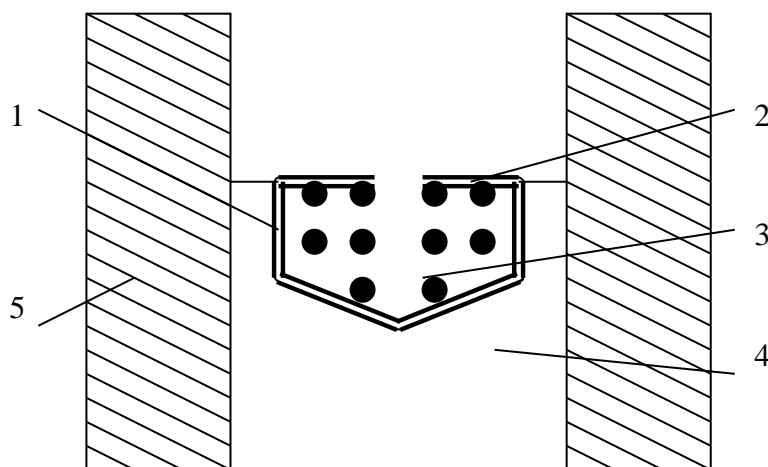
Принципова схема конструкції традиційного ізолюючого склопакета:
